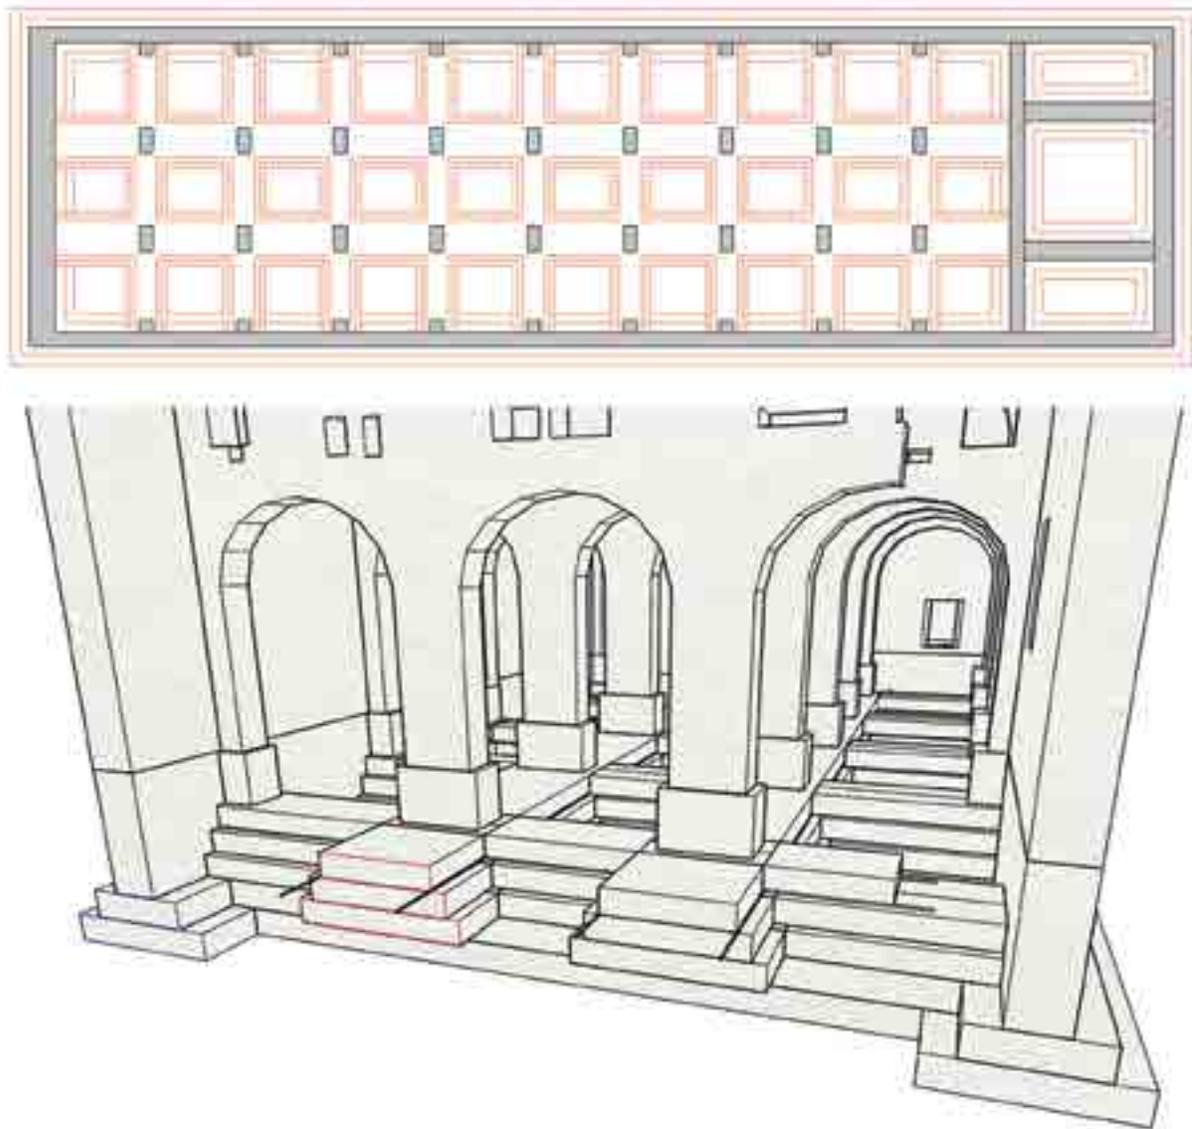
Proposta di consolidamento delle fondazioni tramite sottomurazioni, individuazione intervento e spaccato assometrico. Fonte: Elaborazione degli autori, 2017.
